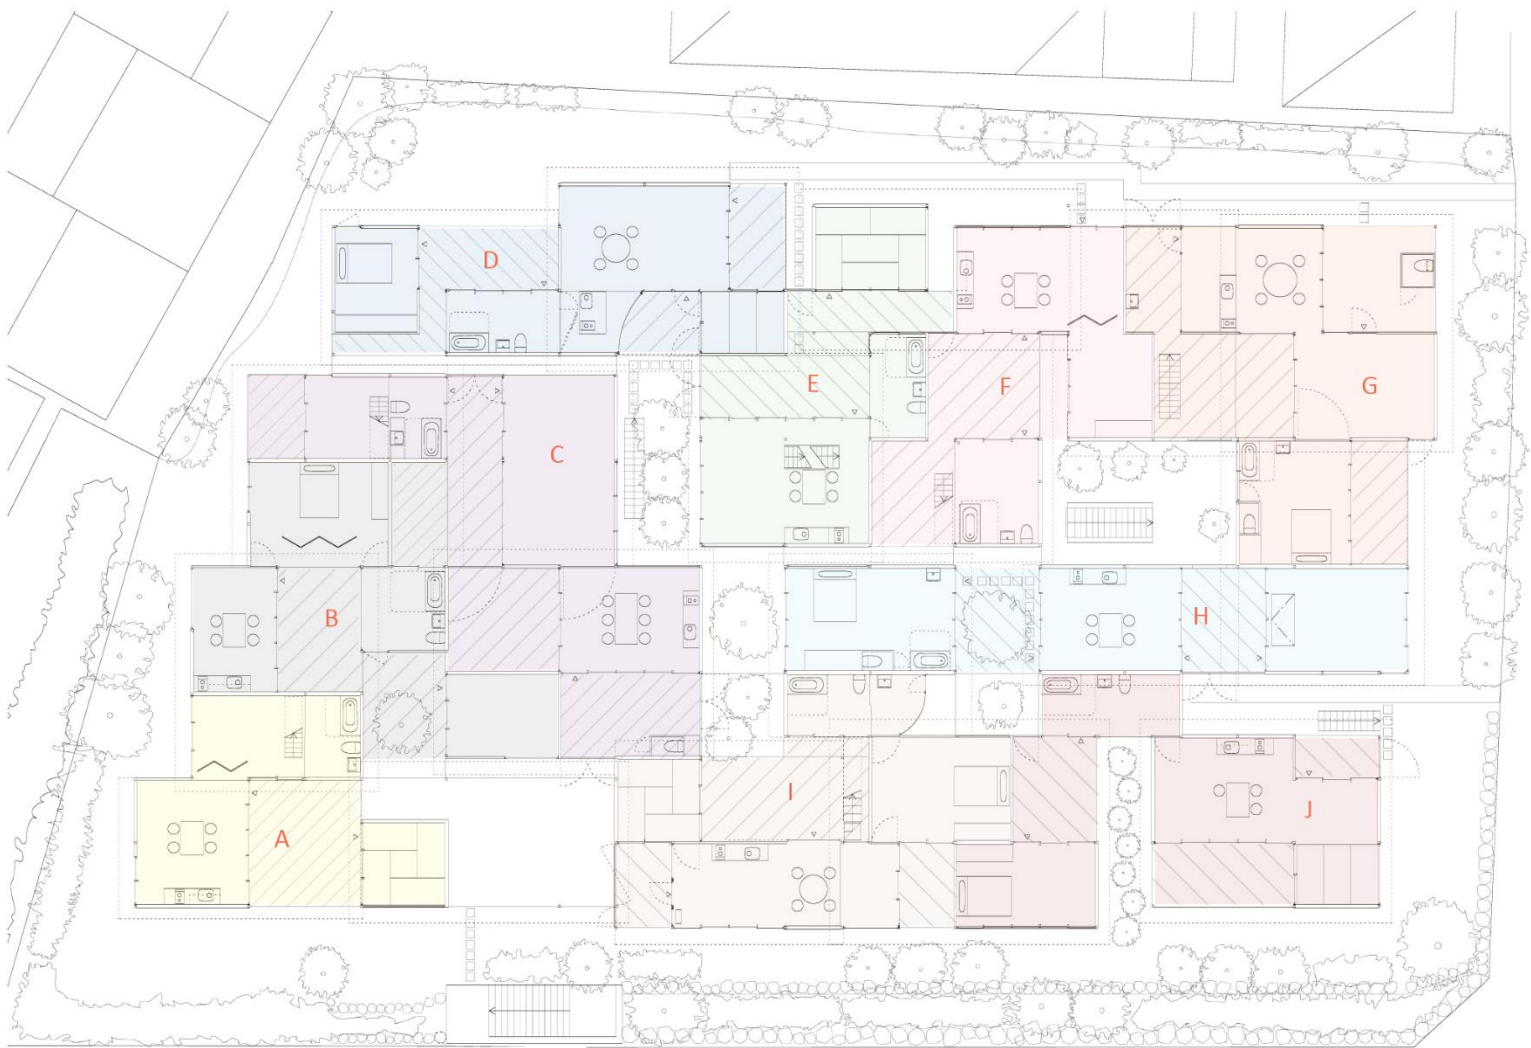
Schémas en coupe et en plan de la répartition des logements du projet Nishinoyama House
